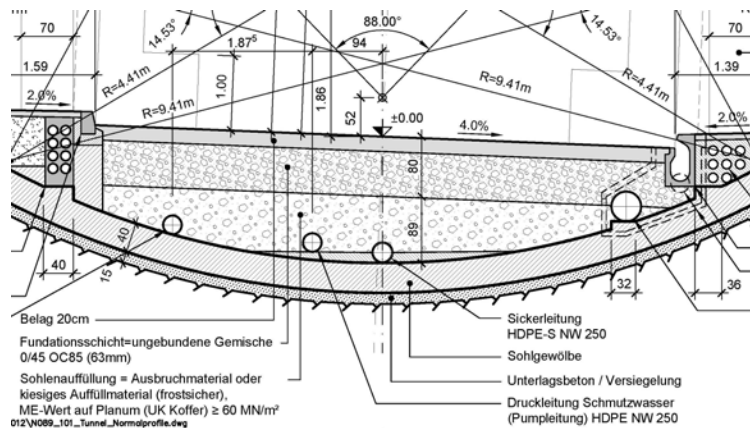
Skizze Sohlenausbau (bergmännischer Tunnelbereich, siehe Plan TU.101)
